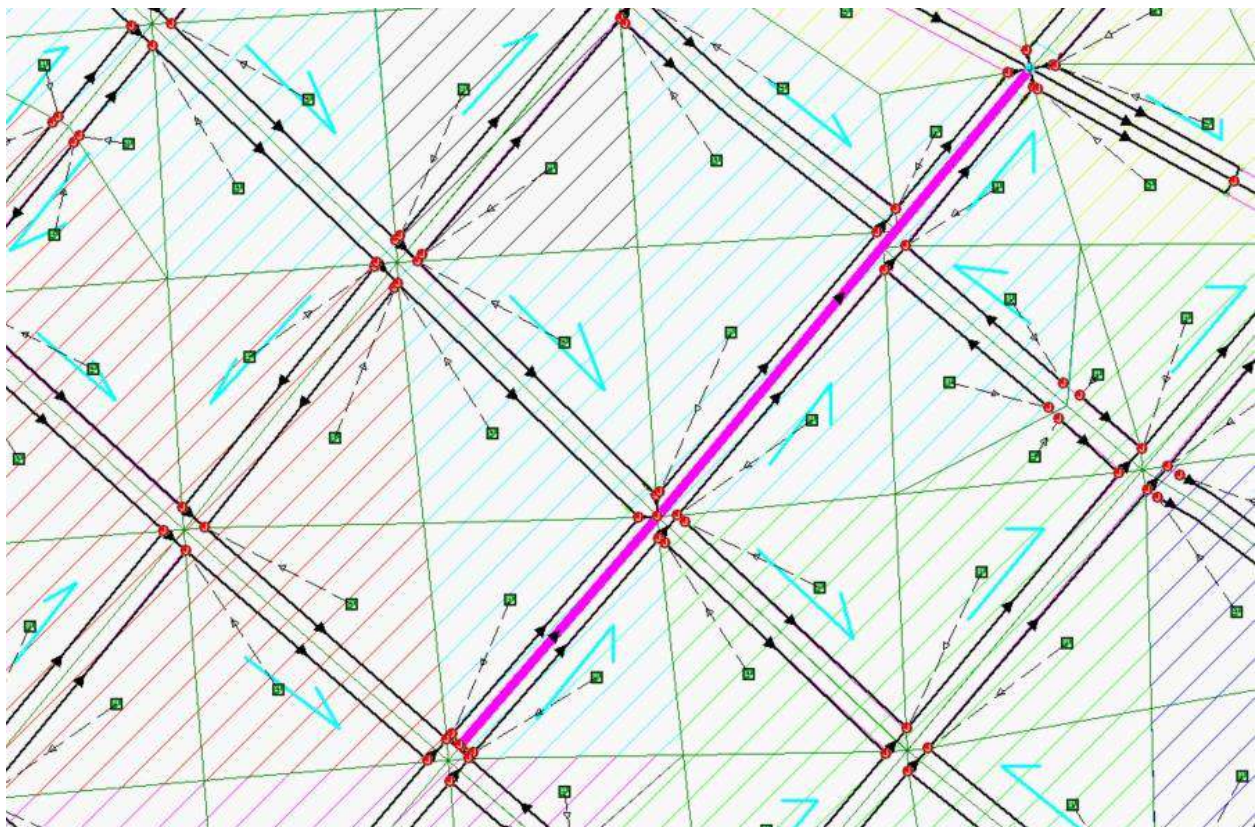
Esquema en planta de la simulación del alcantarillado de la solución propuesta sobre la calle Fulgencio R. Moreno
